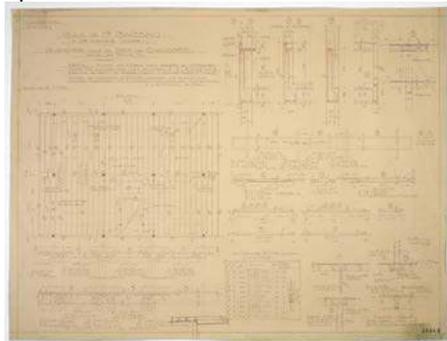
Transición de vigas de canto a planas, villa en Baizeu (FLC 24948).
